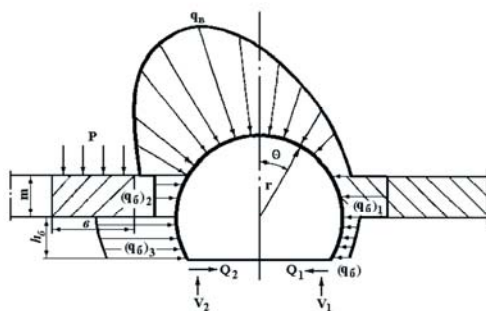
Расчетная схема нагружения крепи выемочной выработки в зоне влияния очистных работ
